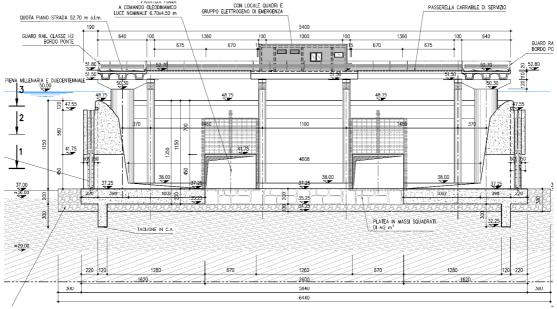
Adeguamento manufatto di regolazione – Sezione tratti longitudinali e vista tratto trasversale
